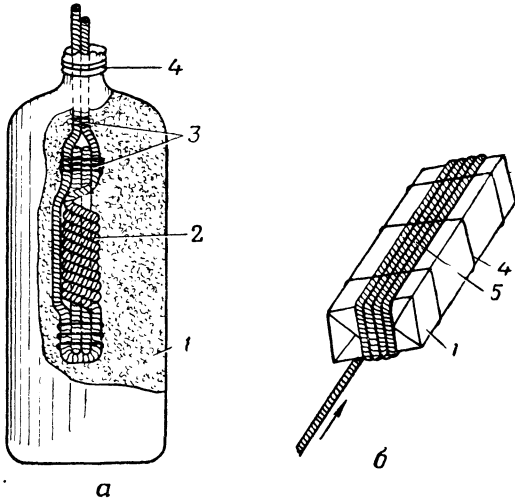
Бескапсюльное взрывание детонирующим шнуром:
